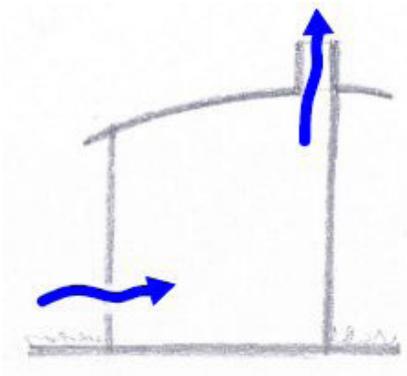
, sistema de ventilación efecto chimenea (2014) Fuente: Imagen de autor.
